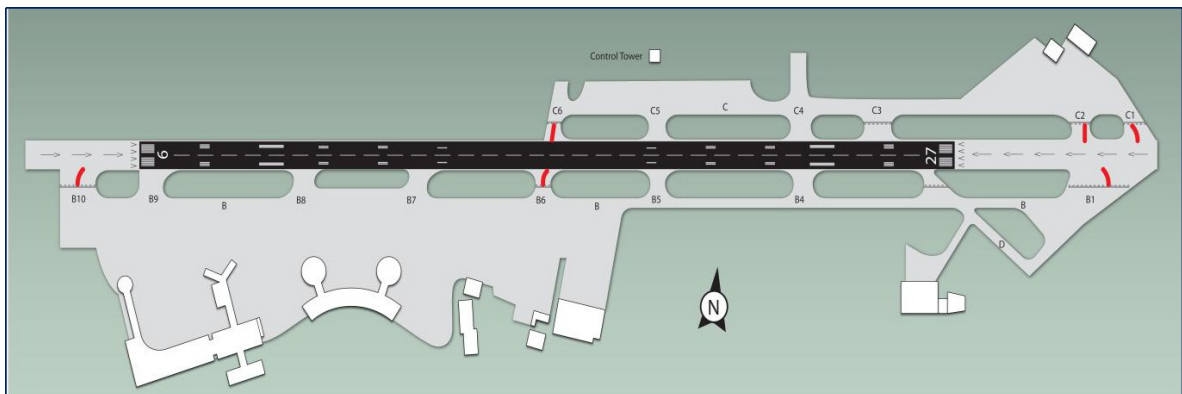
2 圣何塞 (SAN) 机场的跑道状态灯安装平面图
